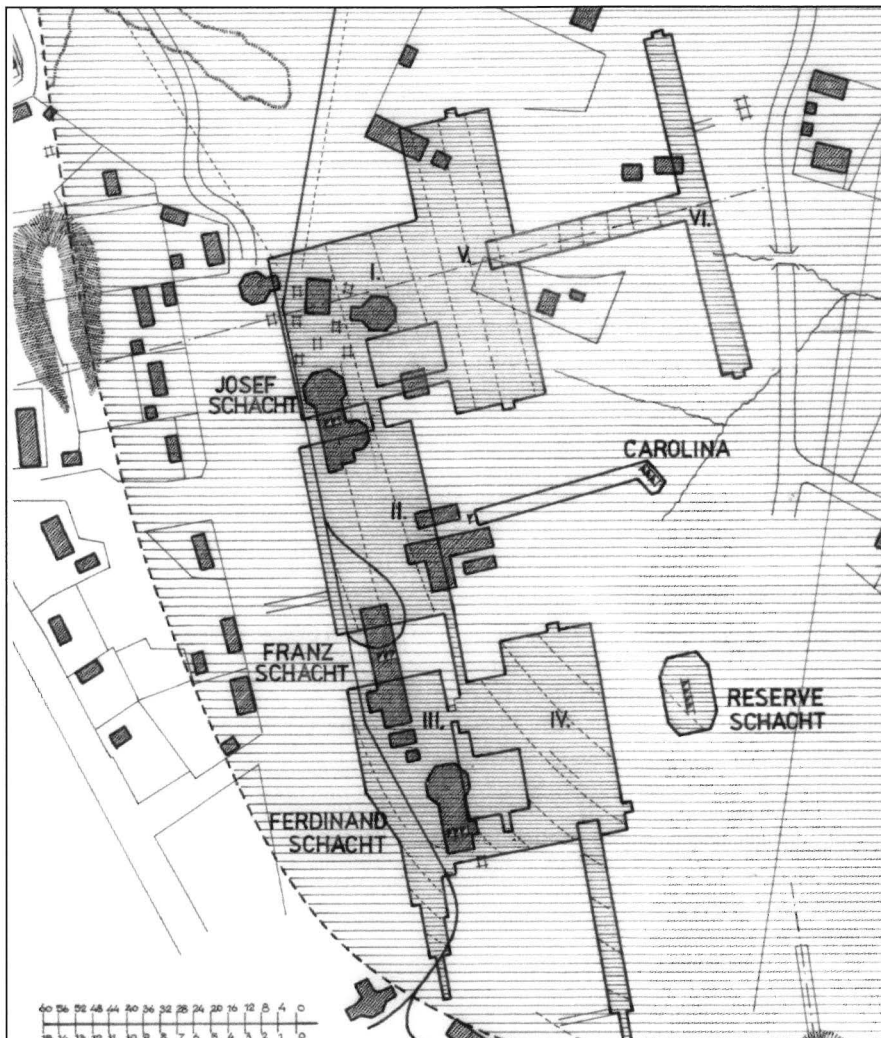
Grundriß der trapezförmigen Salzgruben in Ocna Muresului (nach F. Pošepný)
